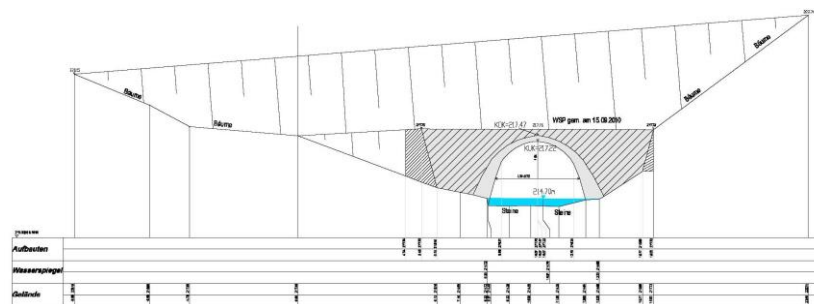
Auslaufbauwerk Ilsetunnel [5]
